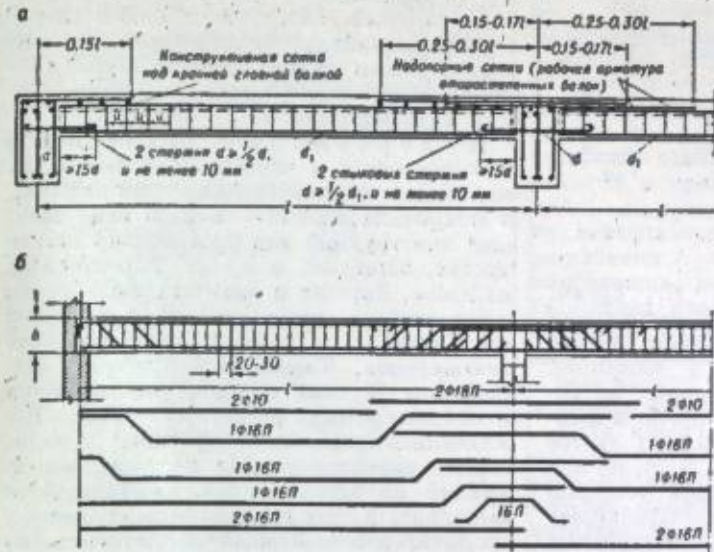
Конструкции второстепенных балок ребристого перекрытия: а — армирование плоскими сварными каркасами и сварными сетками (на опорах); б — армирование отдельными стержнями.
